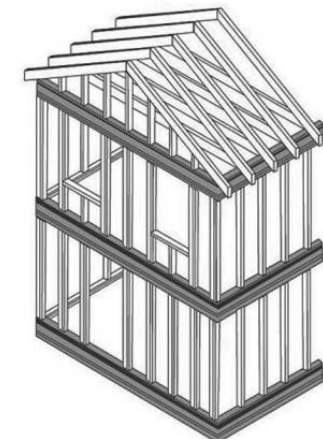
Construcción Balloon Frame o estructura globo de George E. Woodward, Woodward's Country Homes (Nueva York. Woodward, 1969).
